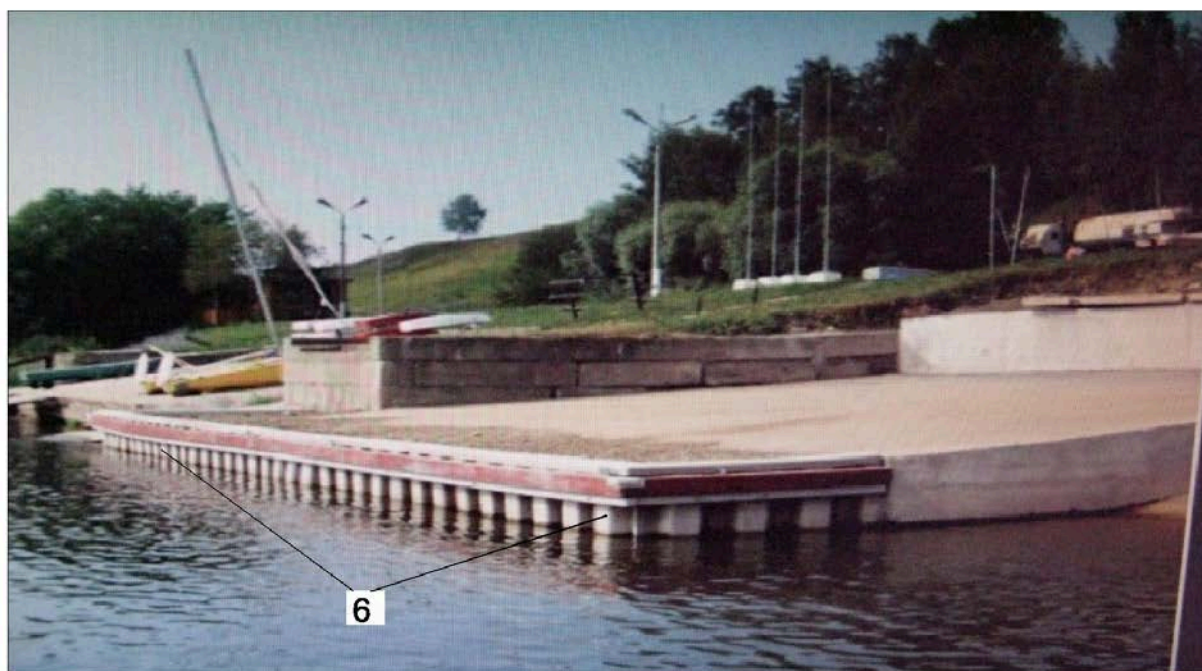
Причальные сооружения на железобетонных сваях:
